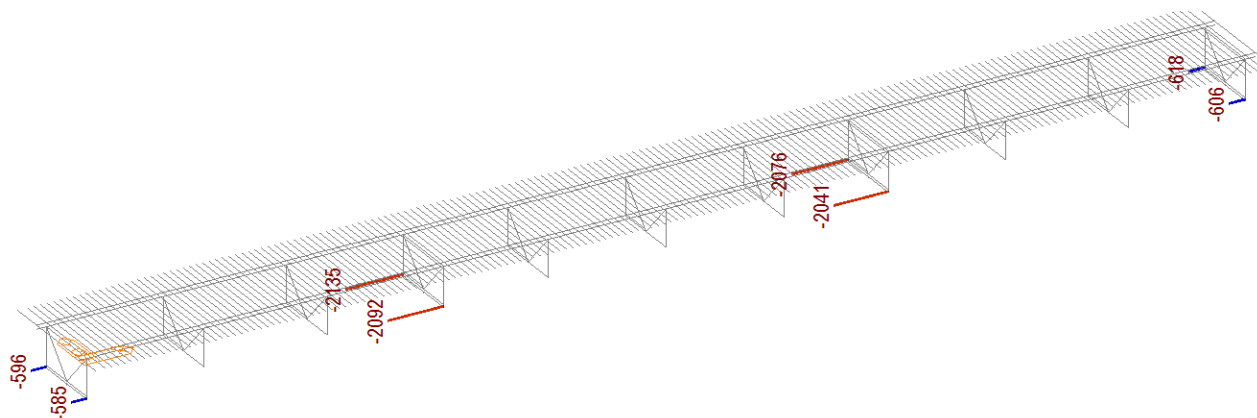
Betonážní úsek 2 (min. přitlak 79 kN, Podpěra 4)
